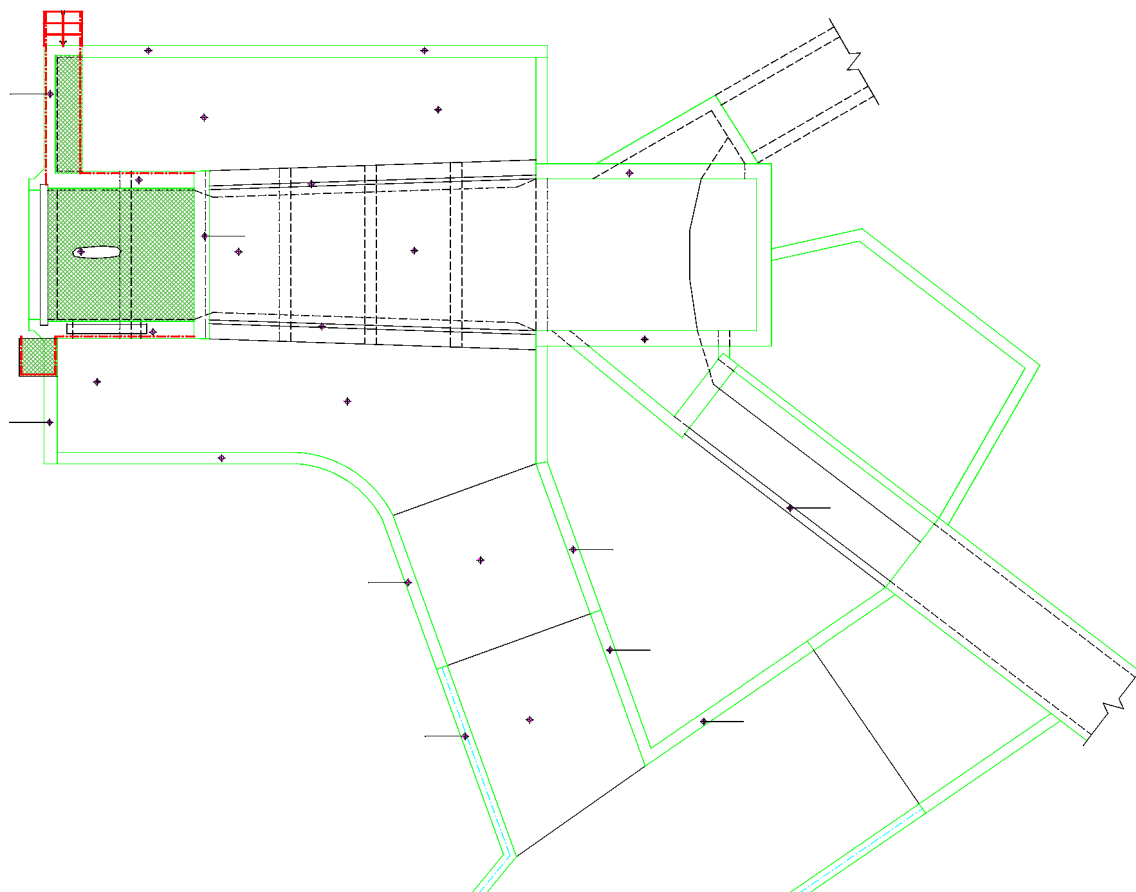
Plano en planta de la obra de llegada de la EDAR Arroyo del Soto. Escala 1/75.
